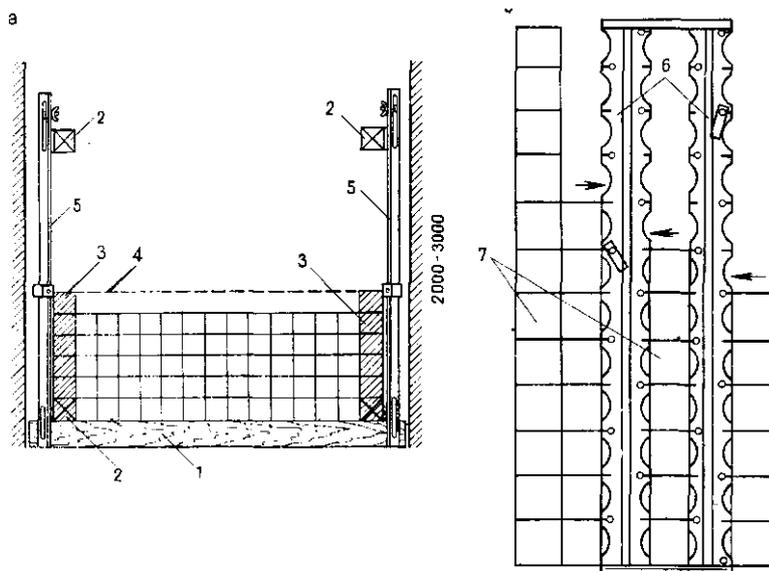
Устройство облицовки стен из керамической плитки на растворе: а - технологическая схема выполнения облицовки; б - схема укладки плиток с помощью шаблона; 1 - горизонтальный брусок; 2 - марки; 3 - маячные ряды; 4 - шнур-причалка; 5 - порядовки; 6 - шаблон; 7 - облицовочные плитки.
